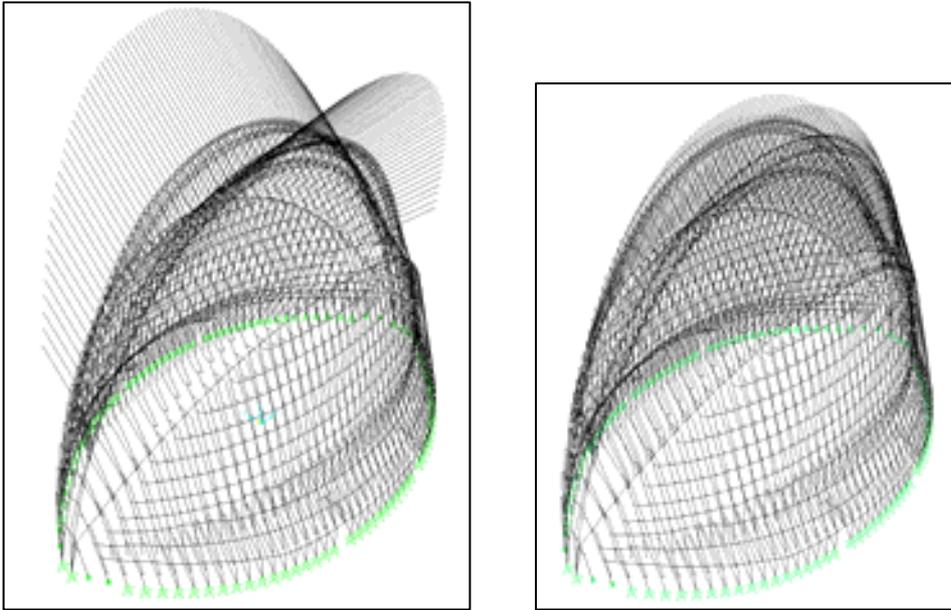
Modelos generales de cálculo con la cubierta en las posiciones abierta y cerrada
